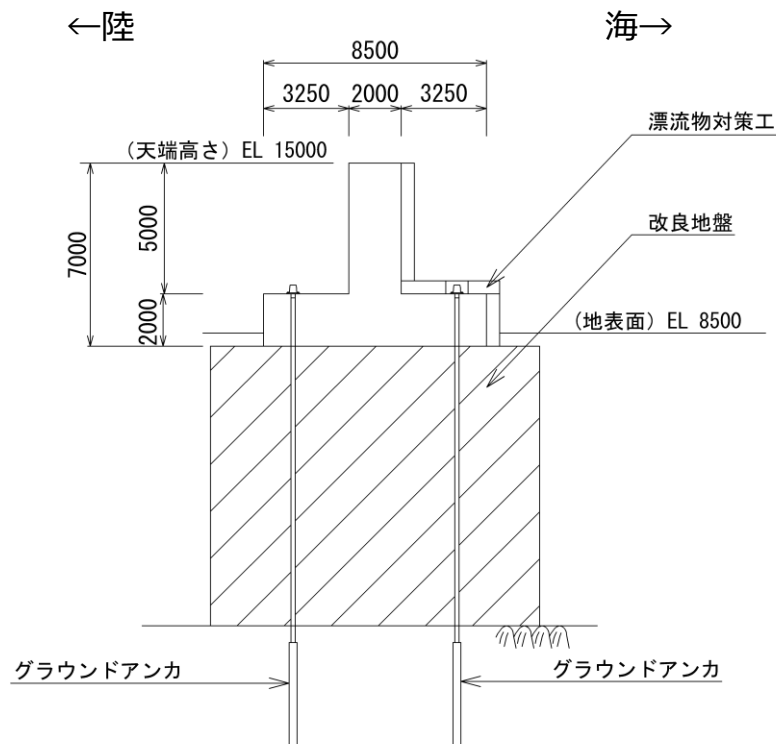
(2) 防波壁 (逆 T 擁壁) の構造図 (断面図)
